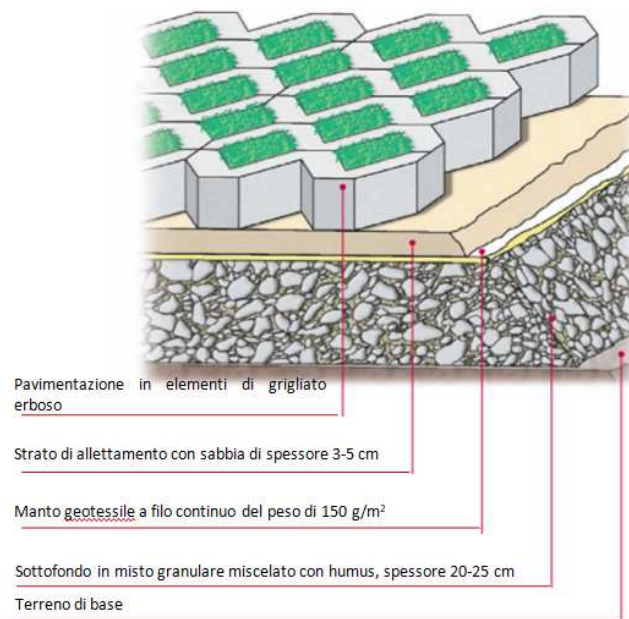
stratigrafia pavimentazione permeabile (www.molinaro.it)
